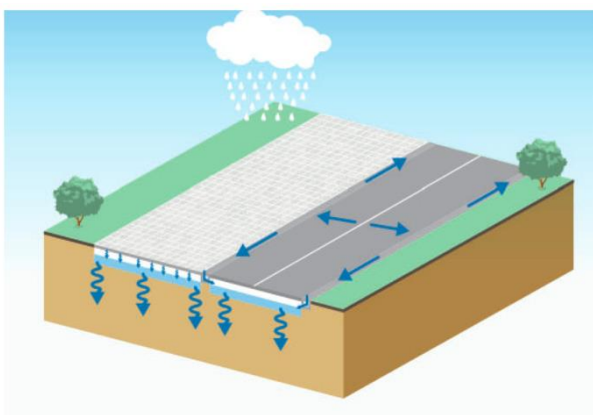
Chaussée à structure réservoir revêtue de pavés poreux (gauche) ou de béton traditionnel (droite). (CERIB, 2021)
